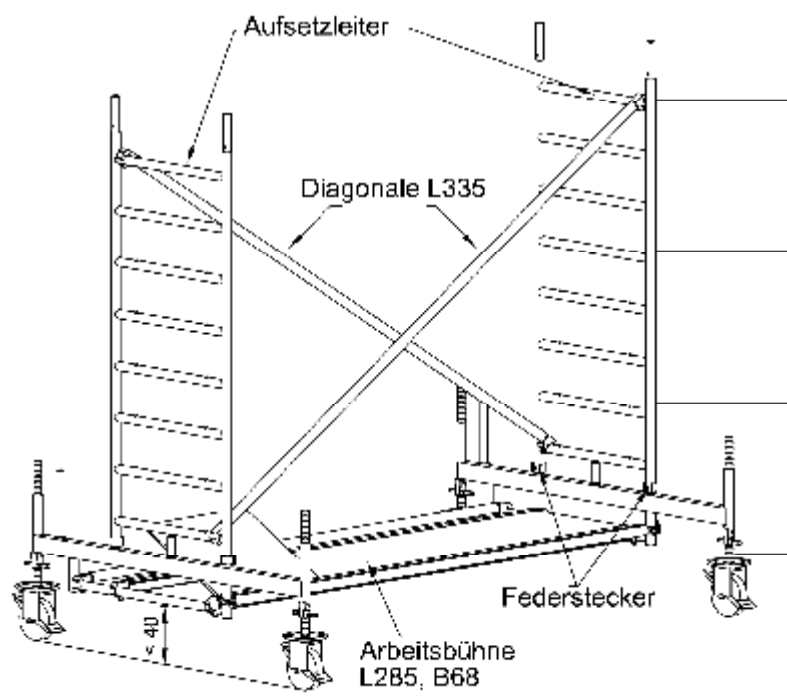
Grundeinheit mit Fahrbalken L180 – mittige Stellung
